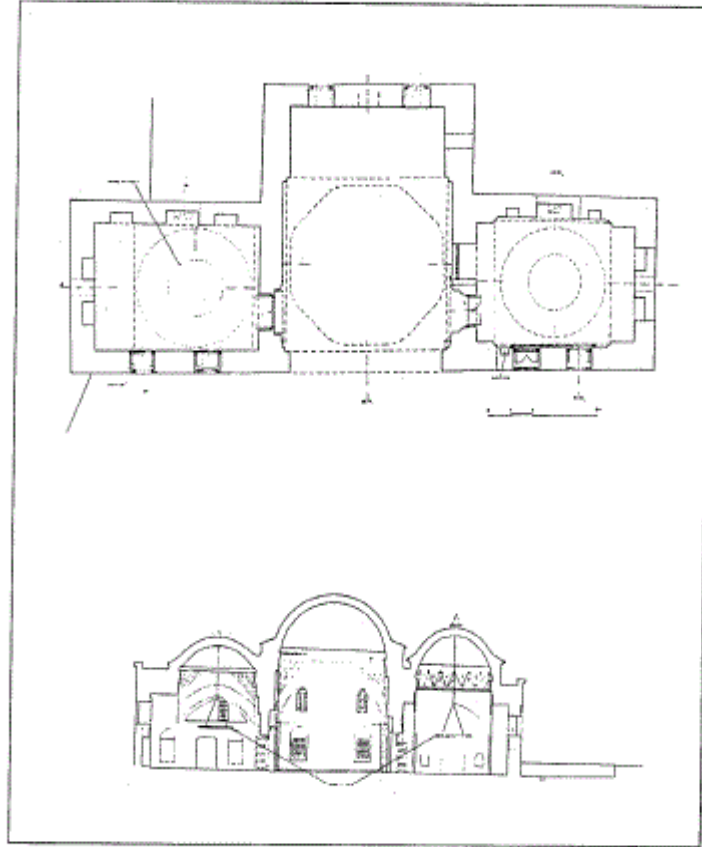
مسقط أفقي وواجهة چشمه قبطان حاجي حسين باشا بإستانبول (عن :
